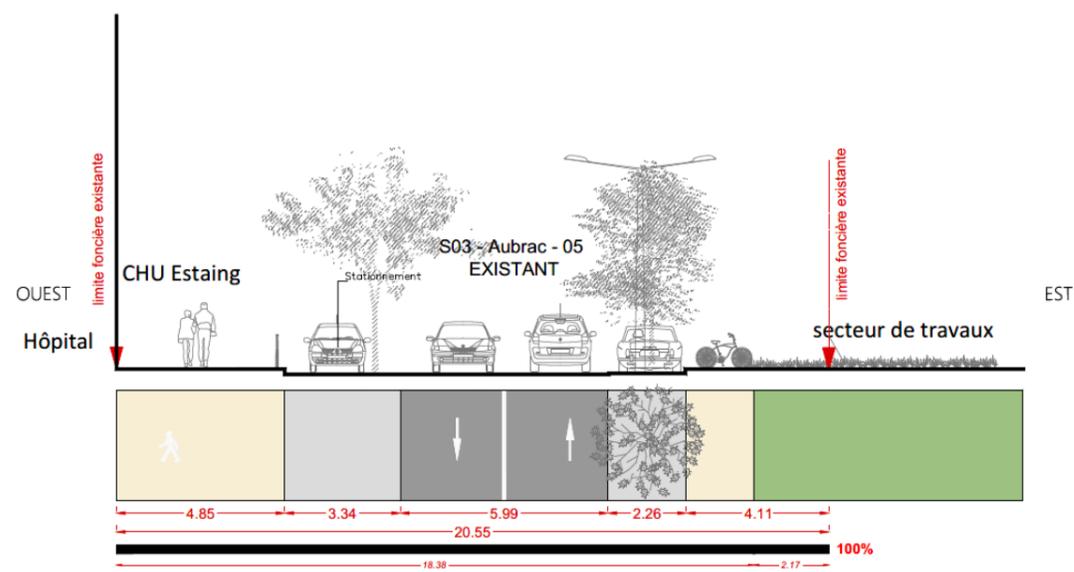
Profil existant sur la rue Aubrac au droit du CHU Estaing
